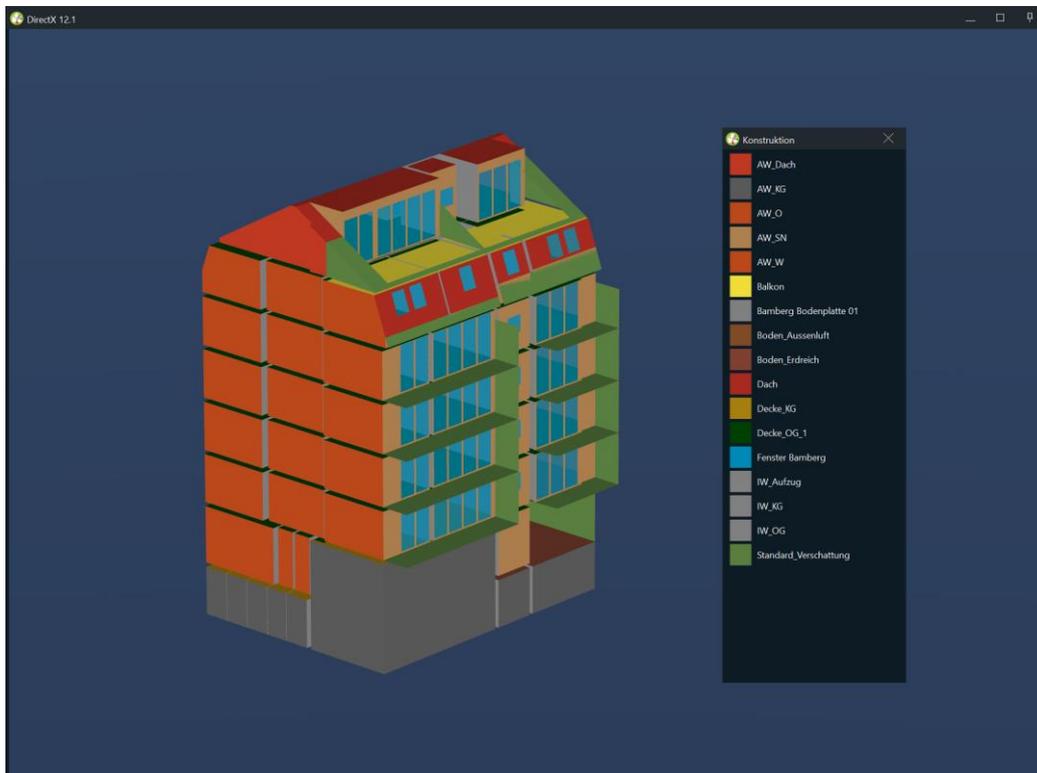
Detailliertes Gebäudemodell Hofansicht Konstruktionsansicht Variante 3
